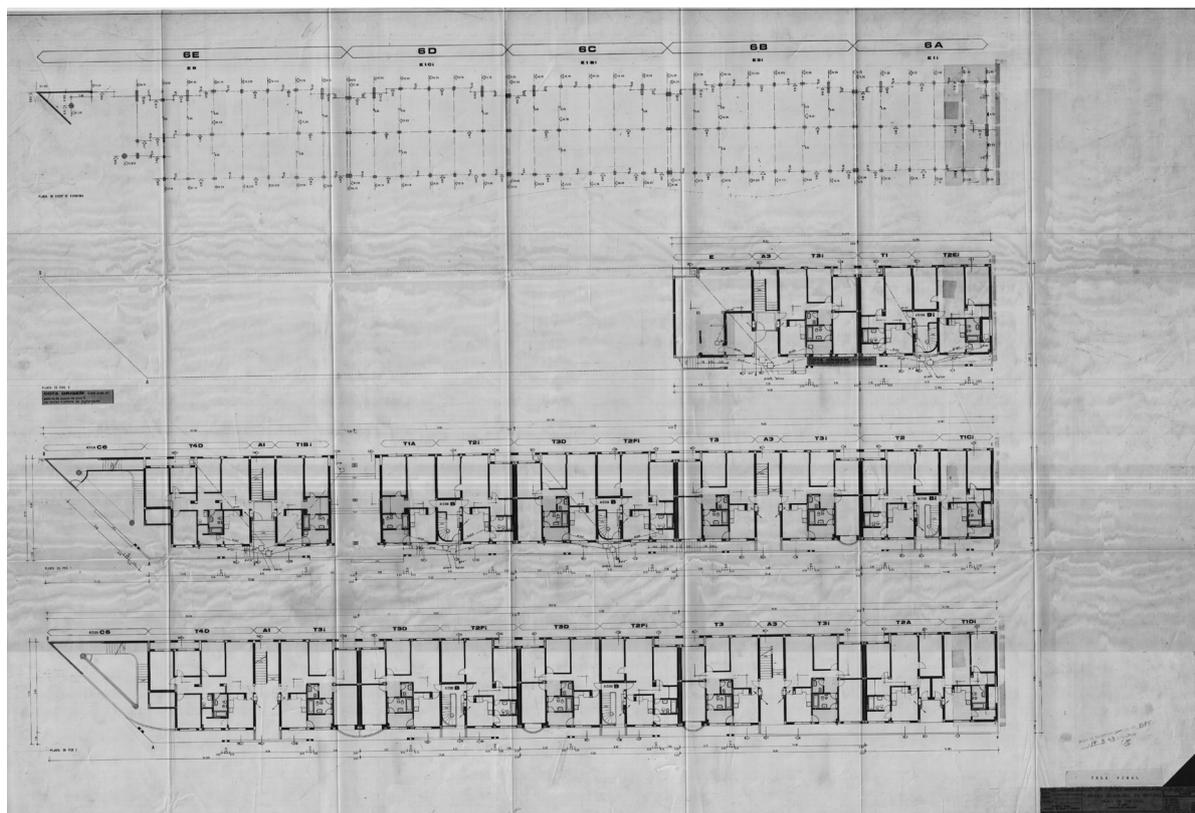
1ª fase do projeto de execução: telas finais, unidade 6, plantas [pisos 0, 1 e 2]
